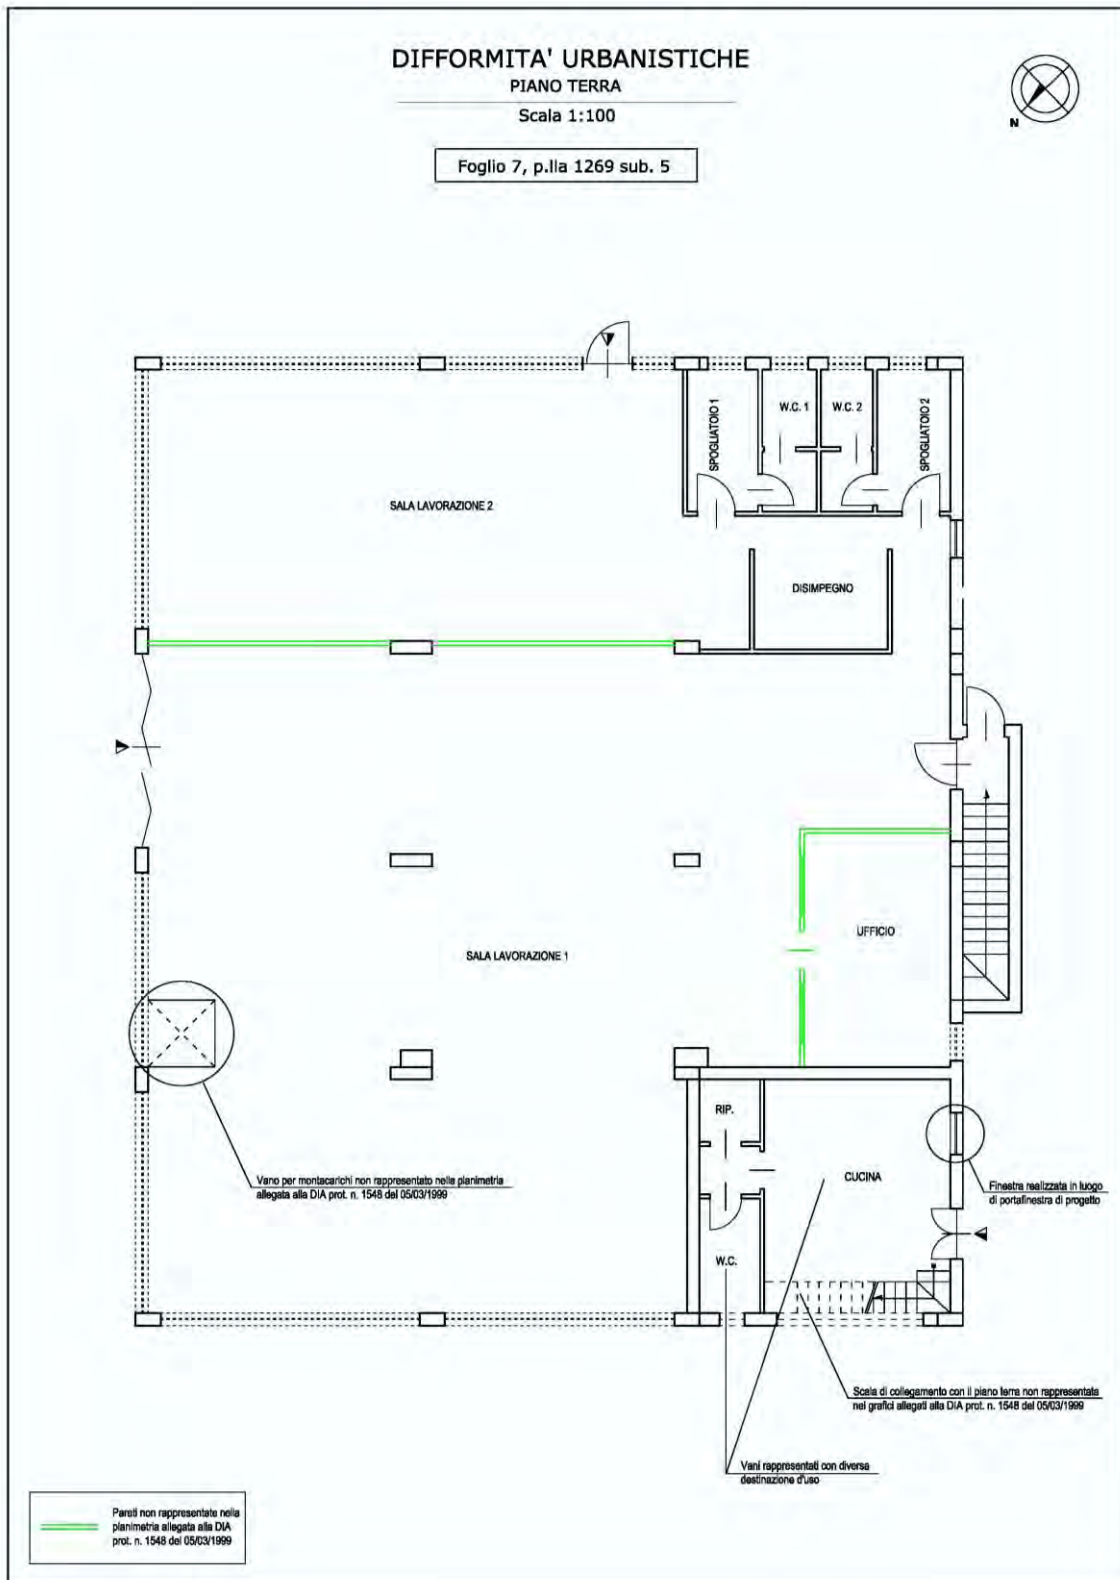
Rappresentazione difformità urbanistiche sub. 5
